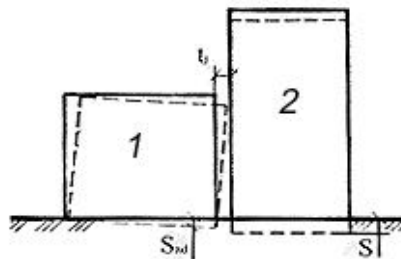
Визначення ширини осадового шва між будівлями: 1 – будівля ранньої споруди; 2 – нова будівля
